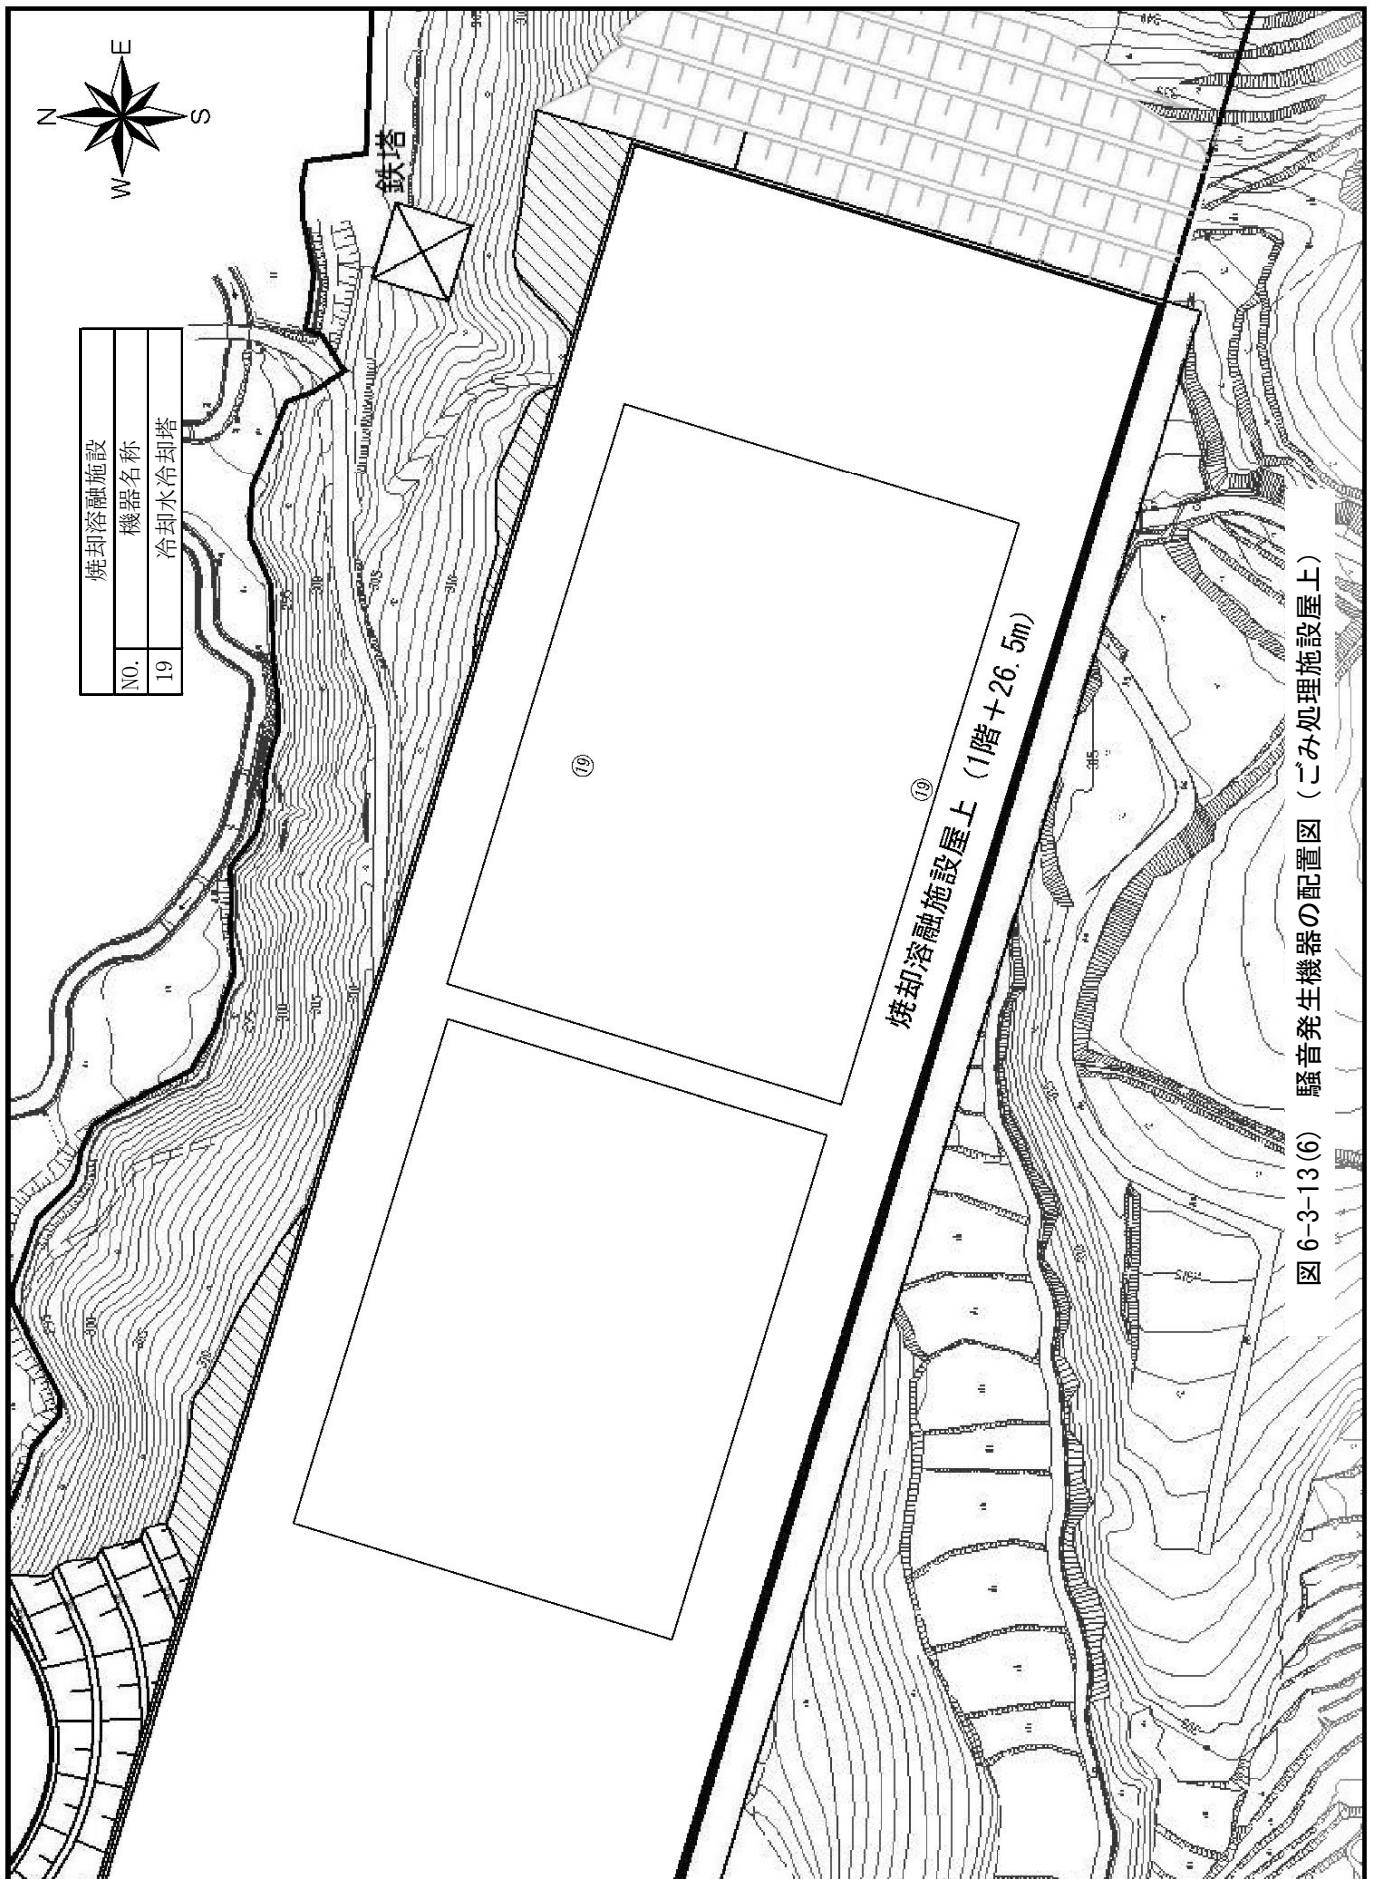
(6) 騒音発生機器の配置図 (ごみ処理施設屋上)
